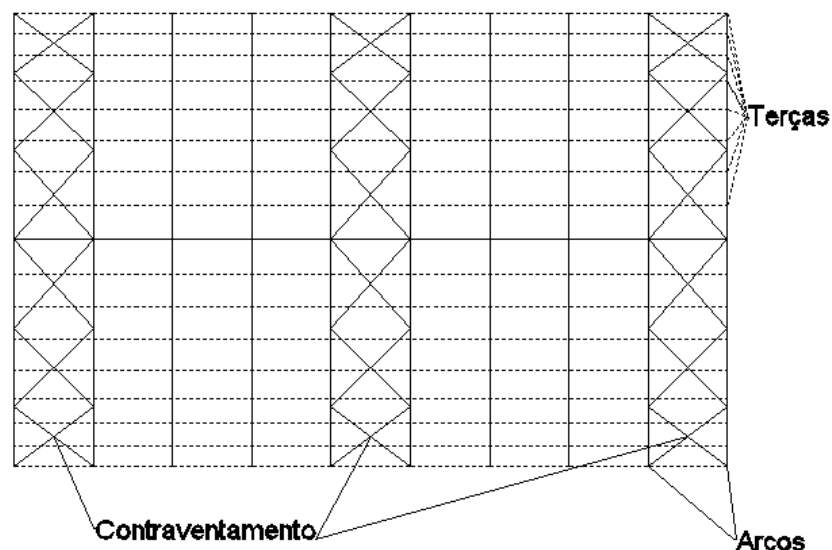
Estrutura de contraventamento (O AUTOR, 2015).
